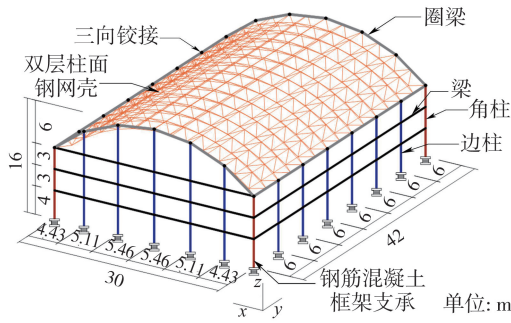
基础隔震钢筋混凝土框架结构支承的网壳结构
